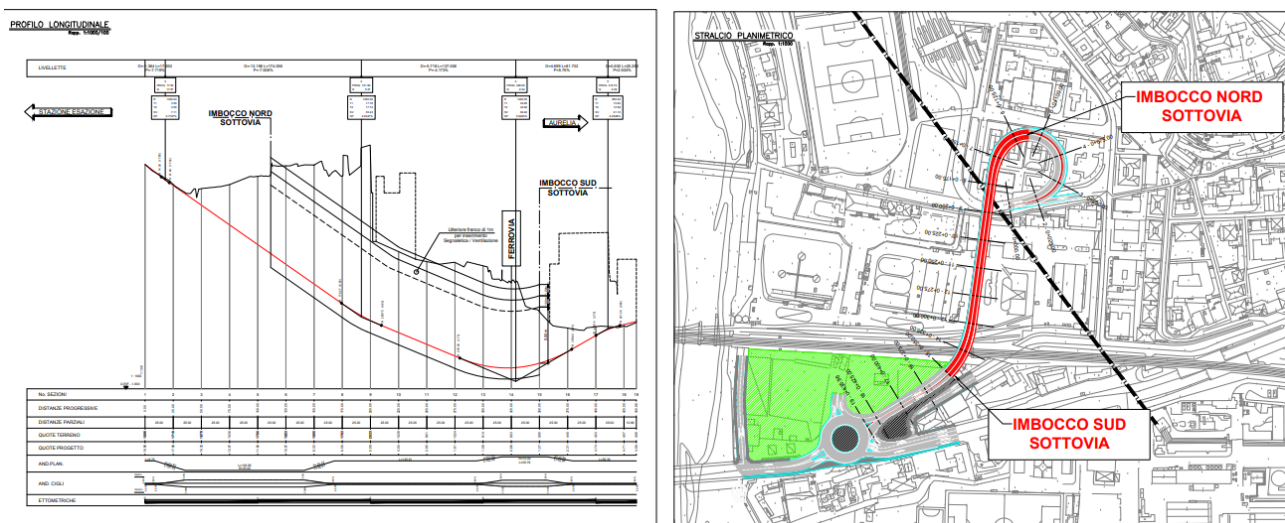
Profilo longitudinale di progetto e stralcio planimetrico del progetto
